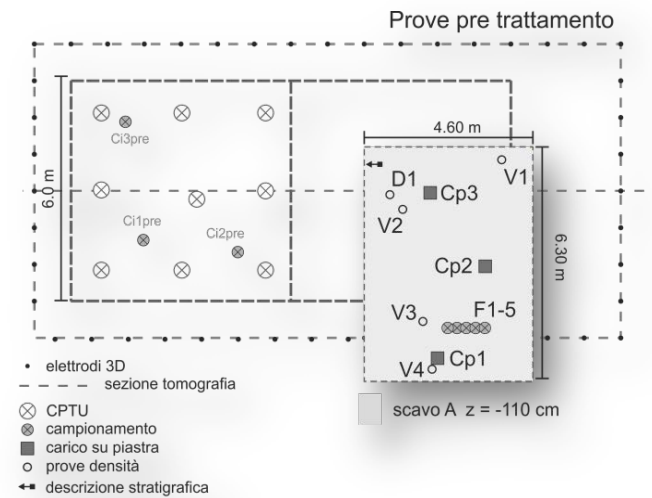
planimetria e ubicazione del campo prove pre trattamento.
